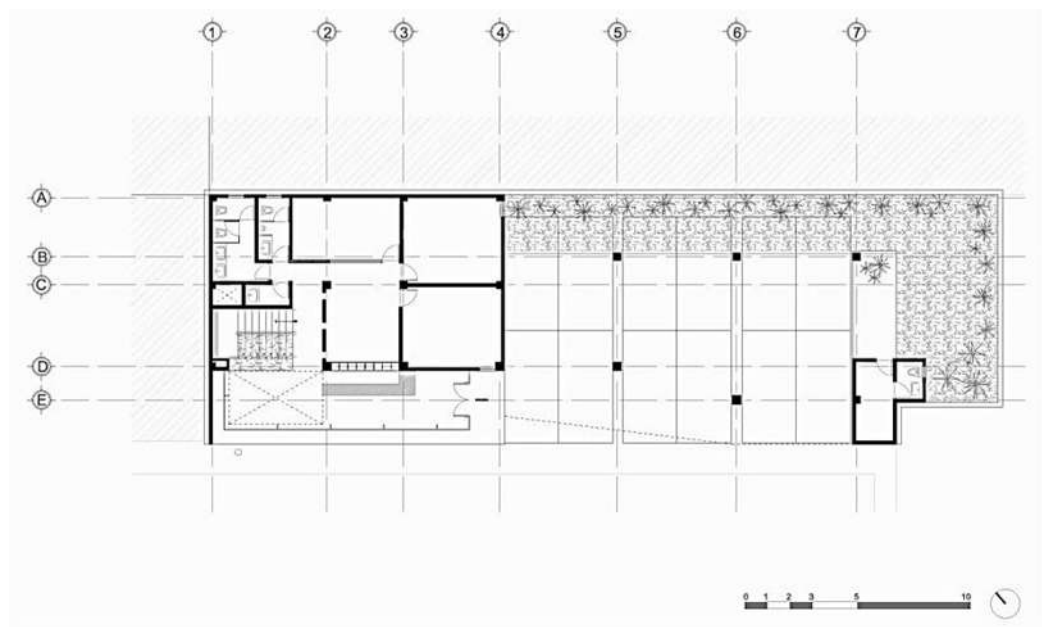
Plano Arquitectónico de la Planta Baja del edificio, en la cual se puede ver todo el programa arquitectónico del Área exterior y la Planta Baja. Fuente Archdaily.com
